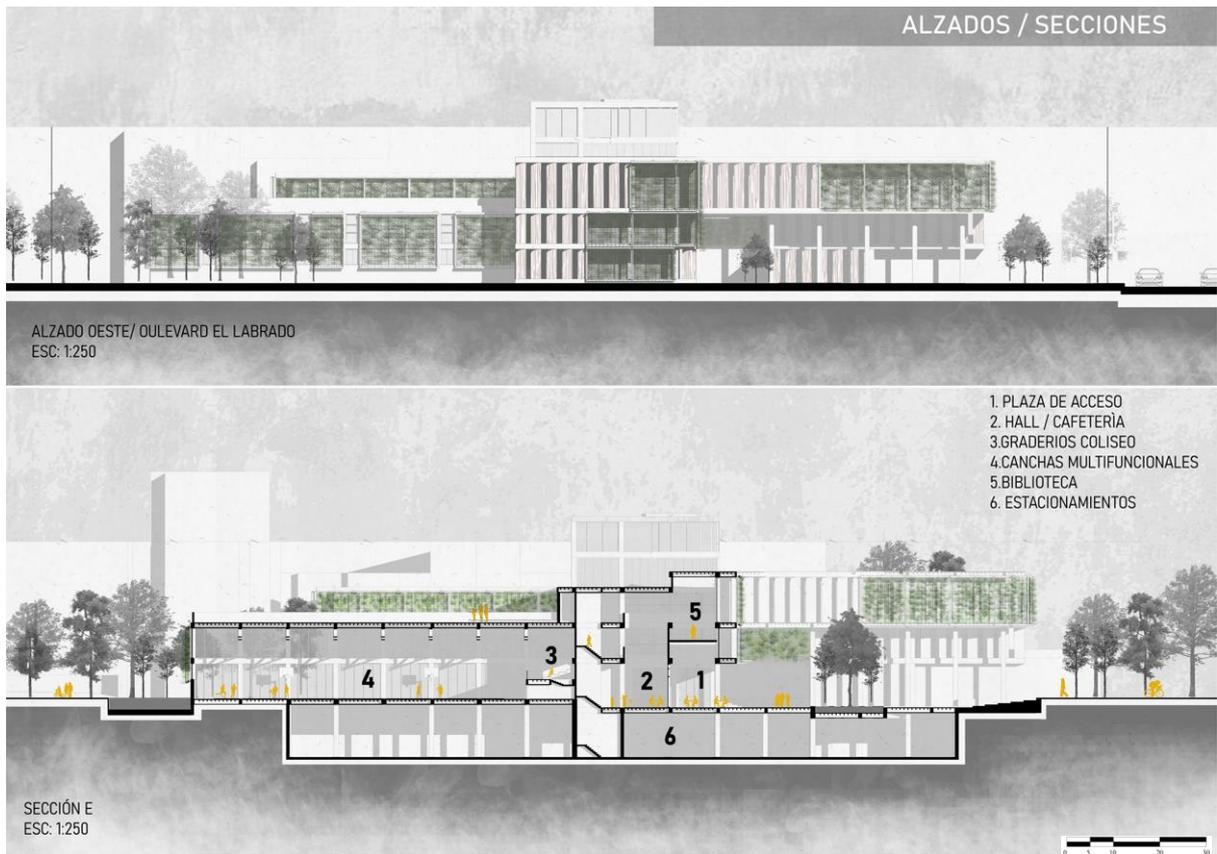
Sección E y Alzado oeste. Elaboración propia.
